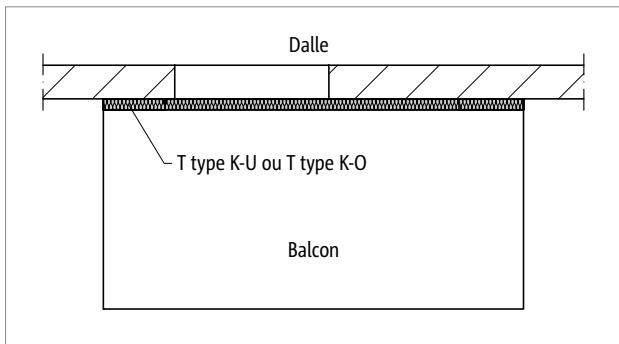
Schöck Isokorb® T types K-U/K-O : balcon en porte-à-faux
